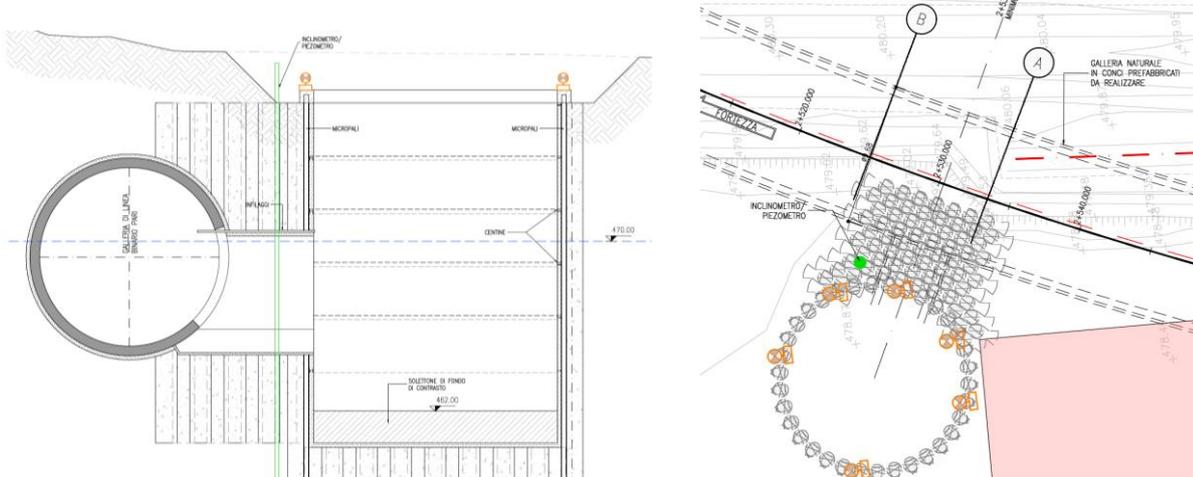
Sezione e pianta del pozzo di minimo idraulico
